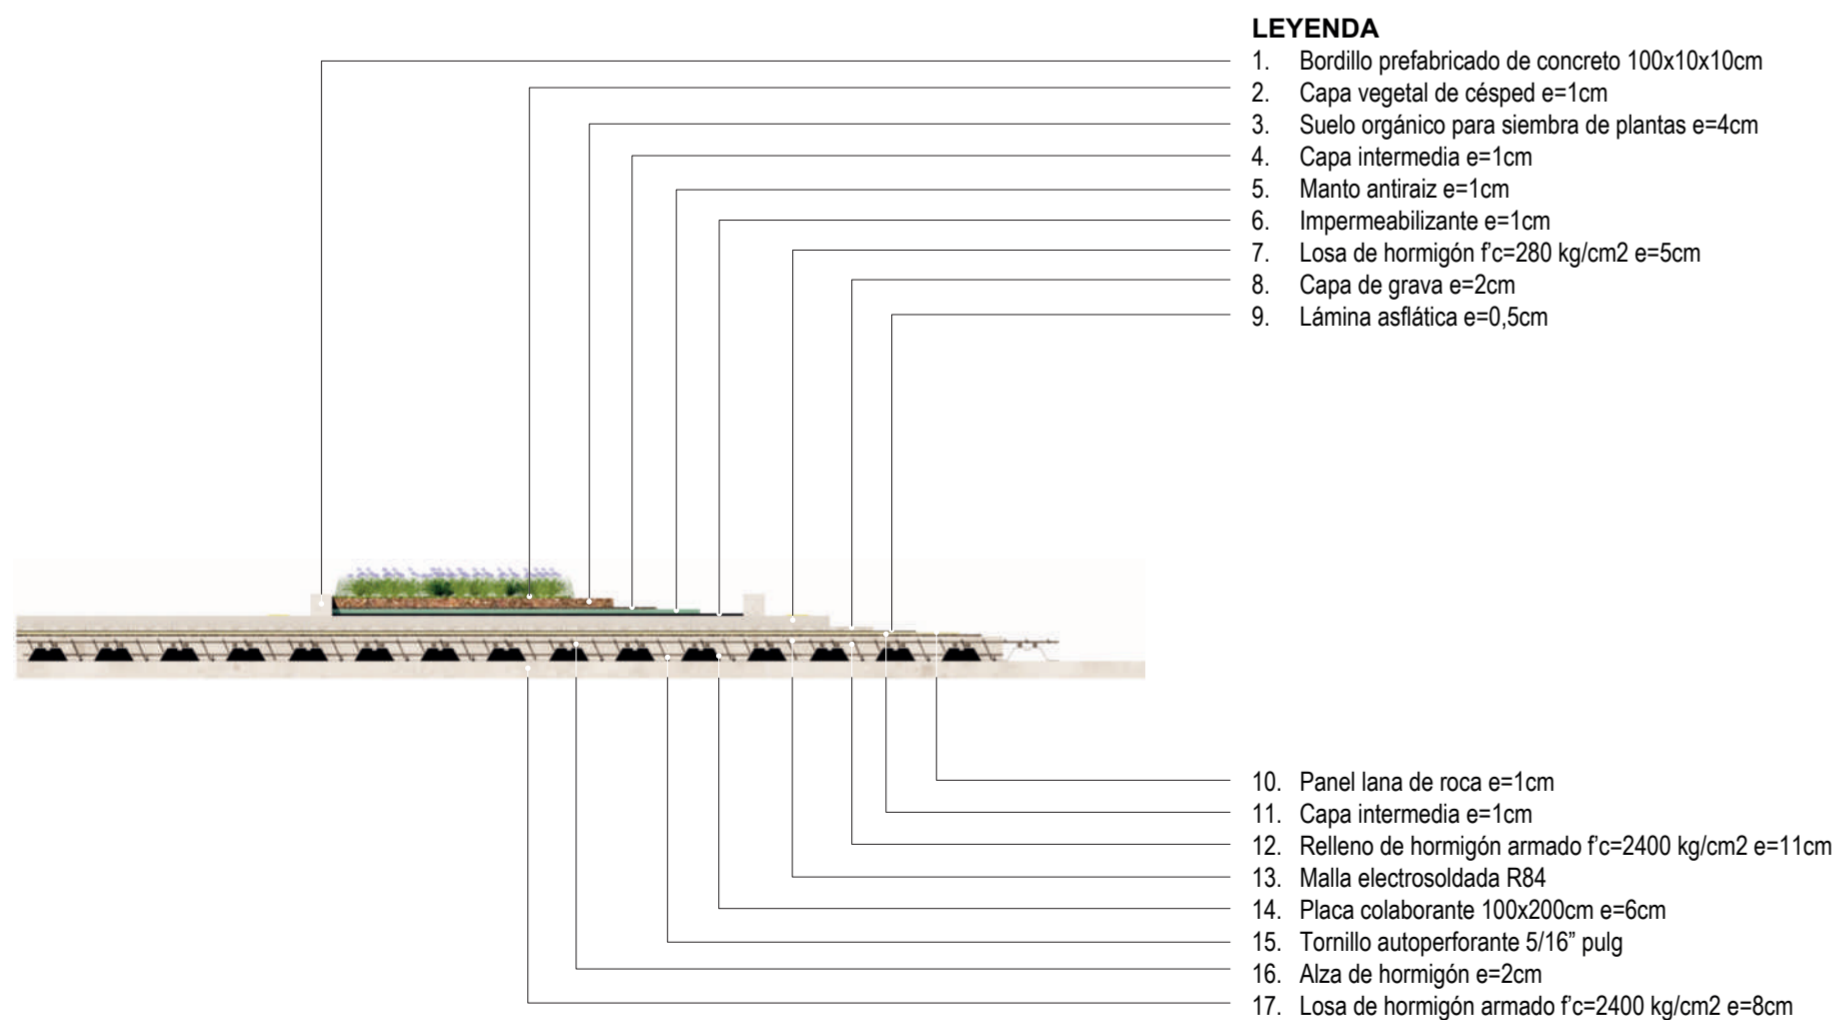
Detalle realista en elevación del sistema constructivo del parterre central ajardinado. Fuente y elaboración: Propia.
